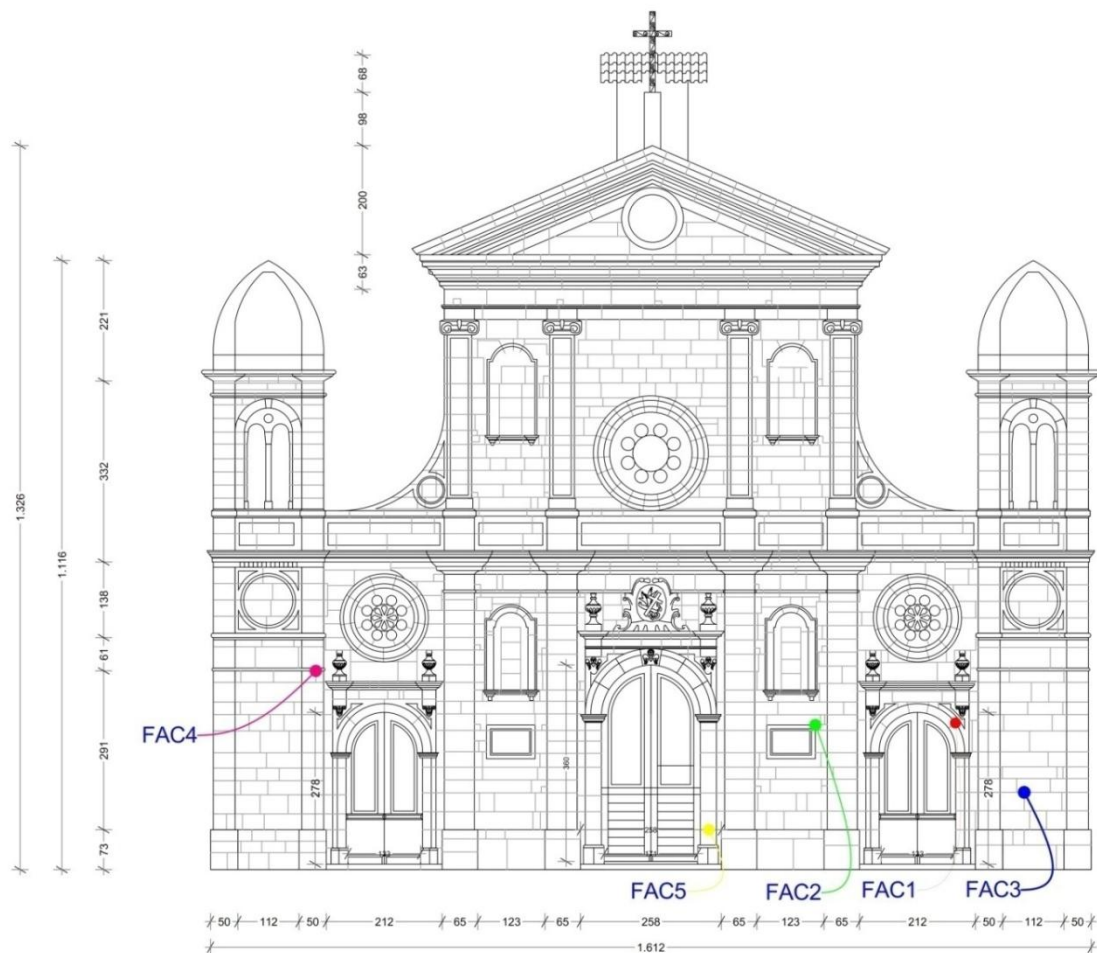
Prospetto facciata con localizzazione dei punti campione.
